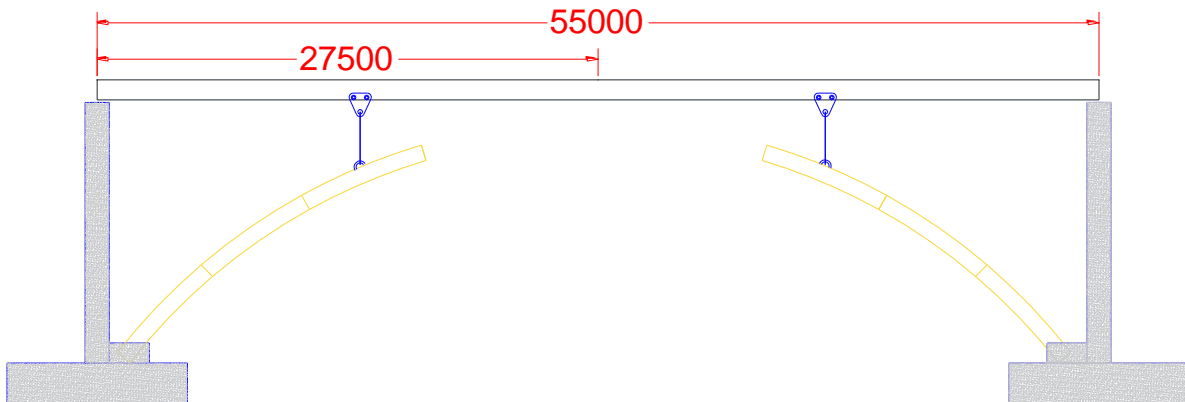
Utilización de la grúa viajera colocada en el patín inferior de las vigas principales.
